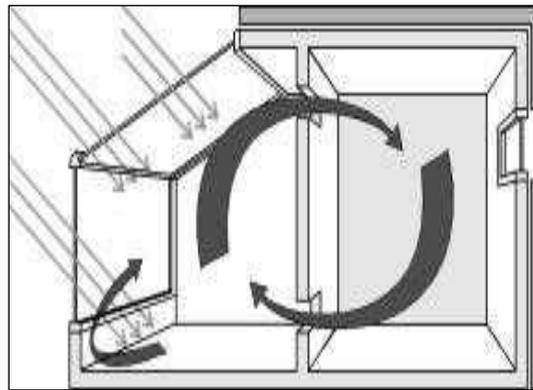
Ganhos isolados por estufa (Construlink, 2006)
